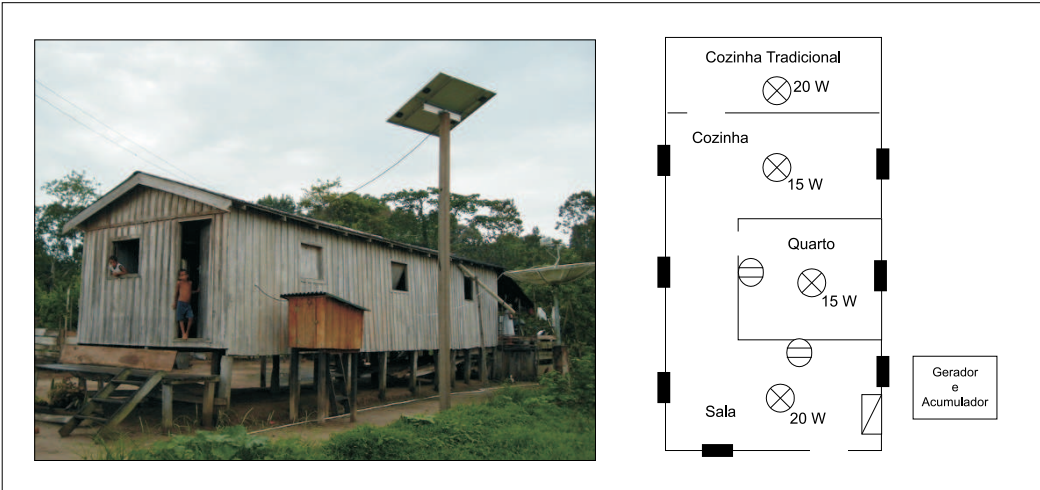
Vista externa do SFD14 e planta aproximada do domicílio.
